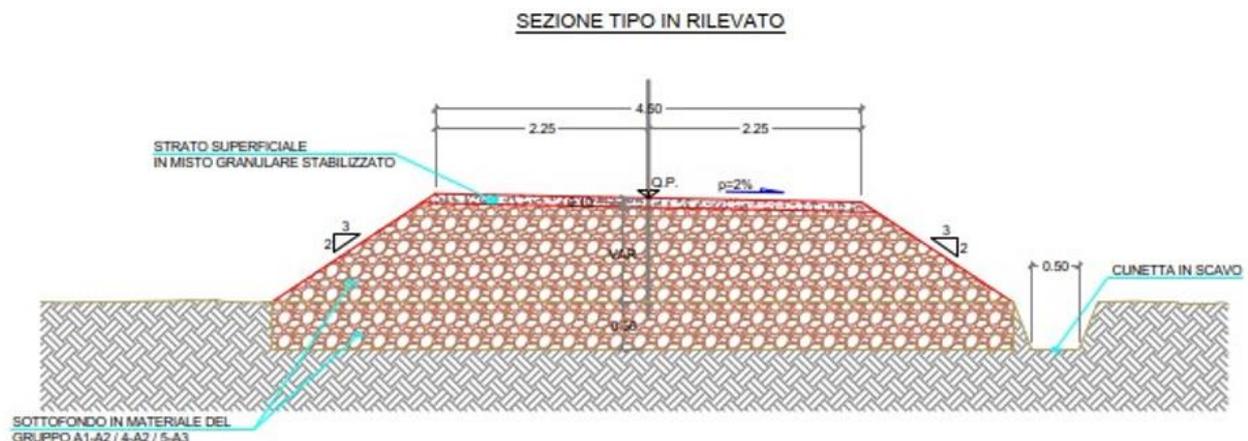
Sezione stradale "tipo" IN RILEVATO della viabilità di progetto (strade di accesso alle piazzole e relativo pacchetto stradale)
